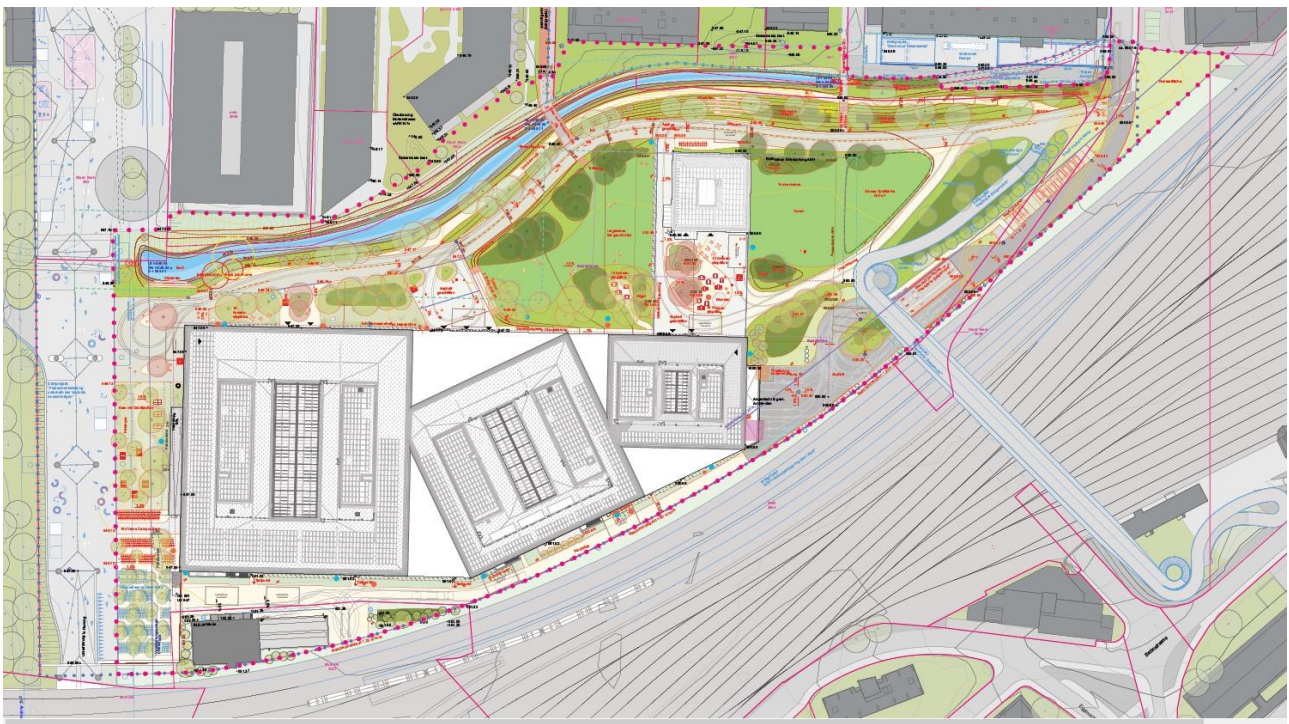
Projekt Campus BFH Situationsplan (Wulf Architekten, Chaves Biedermann, Projektstand Dezember 2022)
